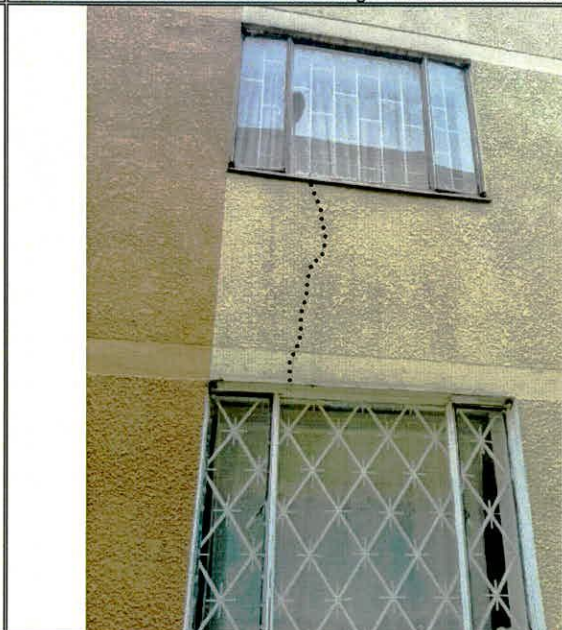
Fisuras identificadas en muros de los bloques de apartamentos de la Agrupación de Vivienda Multifamiliares Prado Veraniego, ubicada en el predio de la Carrera 54 B No. 128 – 39, en el Sector Catastral Prado Veraniego Sur de la Localidad Suba.
